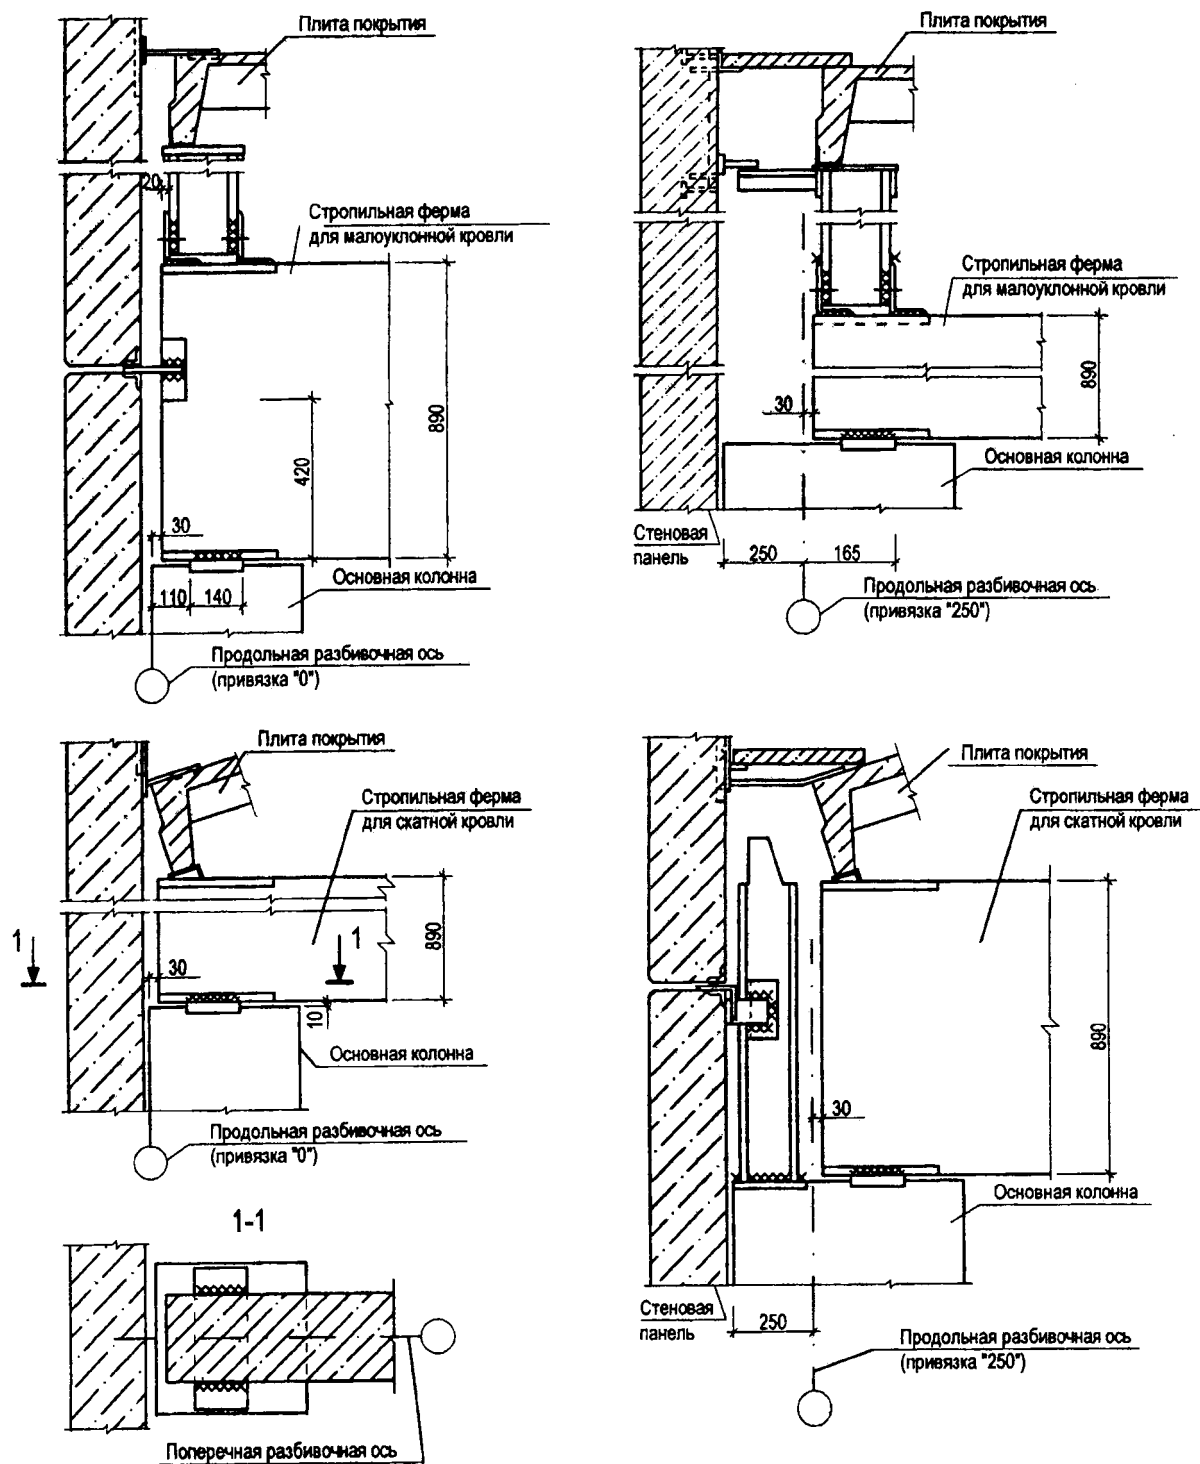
Узлы опирания стропильных ферм на колонны
